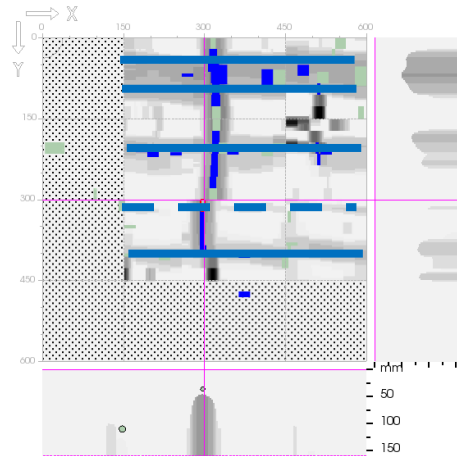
Poutre Pt05 – Travée 2 à mi-travée
